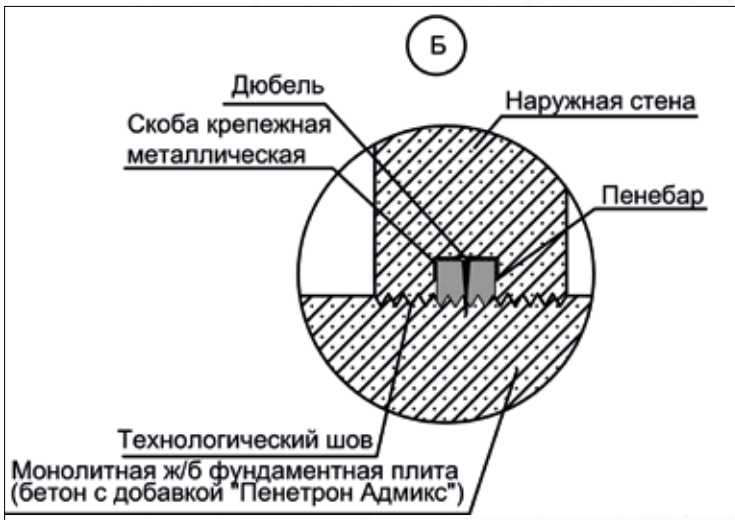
Гидроизоляция шва бетонирования (технологического шва) примыкания стена-пол
